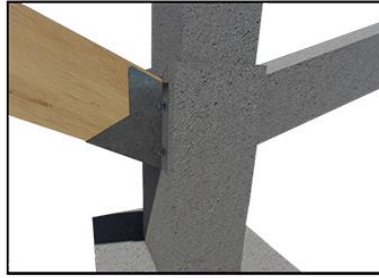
Detalle estructural uniones de Vigas a pedestal. Elaboración propia.
